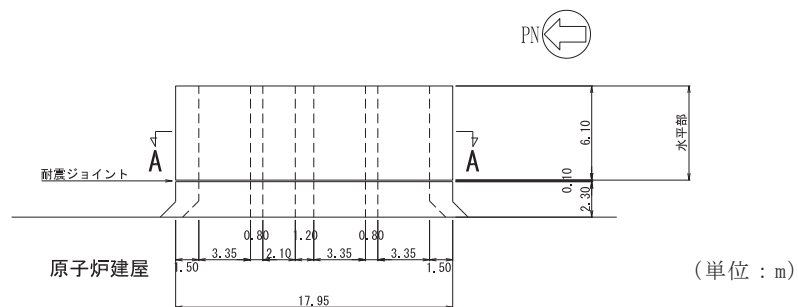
原子炉機器冷却海水配管ダクト平面図
